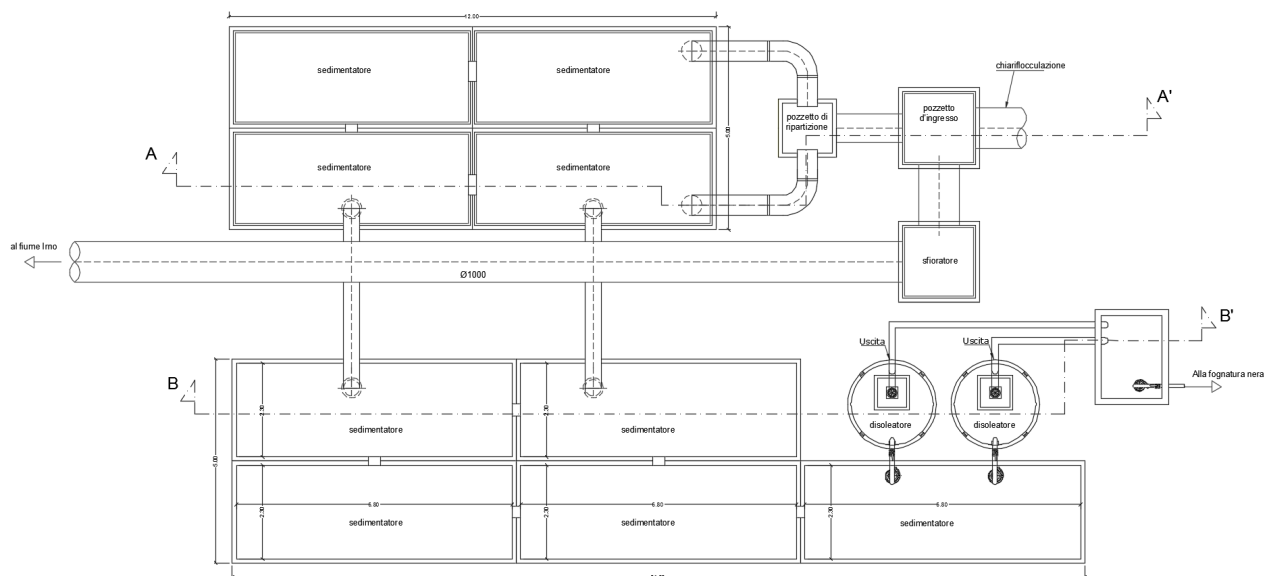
Pianta con collegamento idraulico dell'esistente vasca con le nuove
